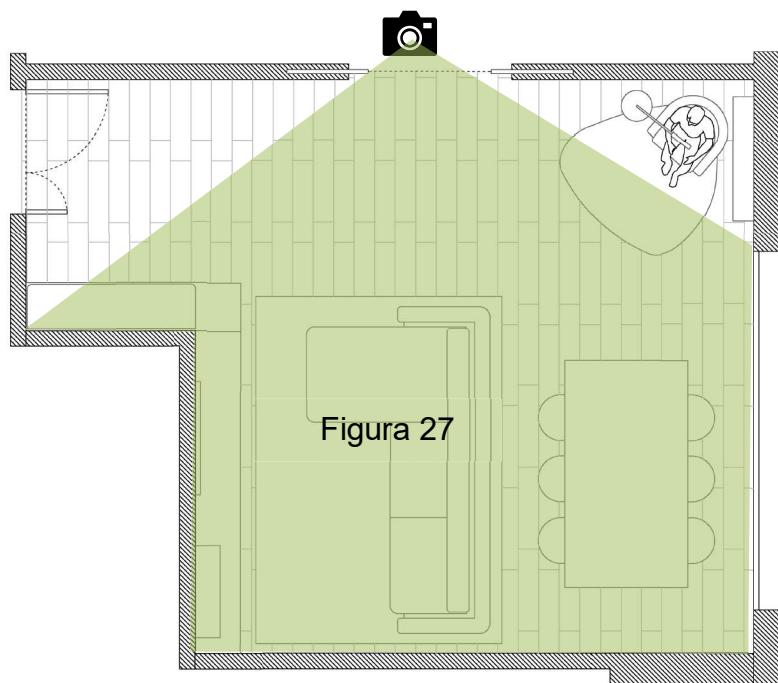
Planta com indicação de vista Sala (Projeto AP)
